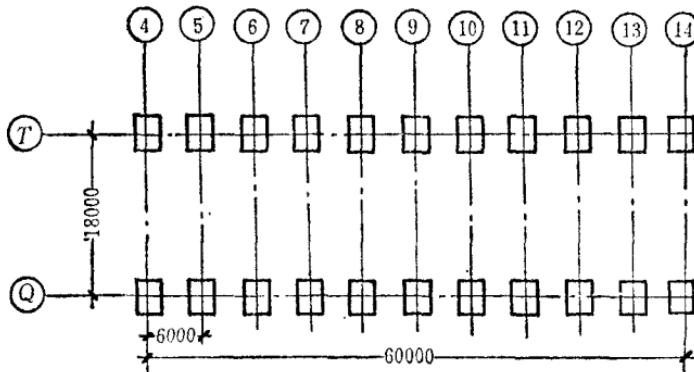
内蒙大林型砂厂选砂车间柱子基础平面布置图
